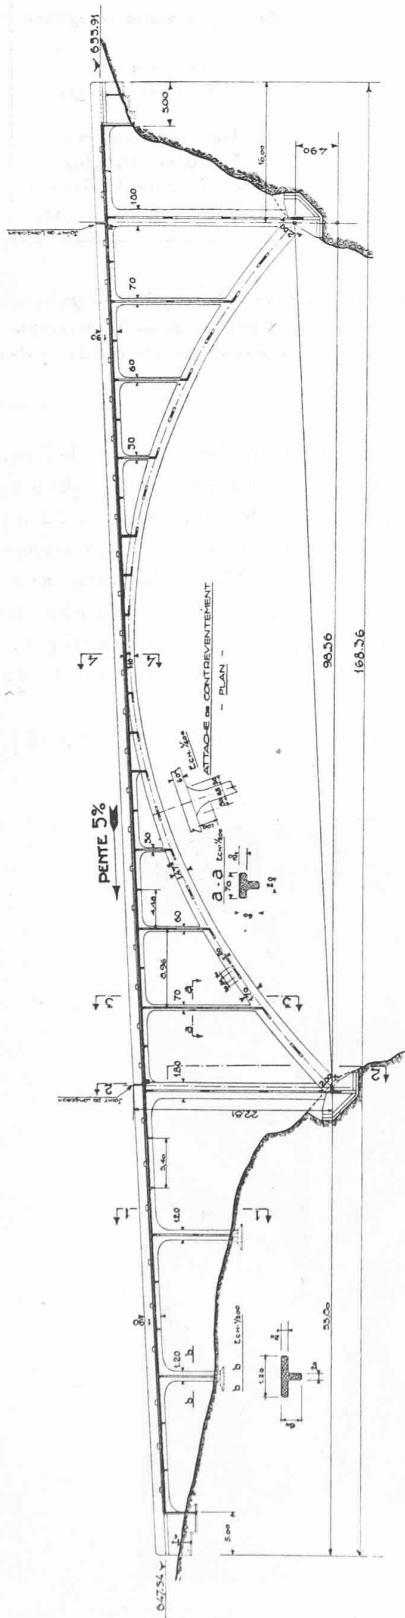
Pont sur le Trient, à Gueuroz. Coupe longitudinale 1 : 800.
